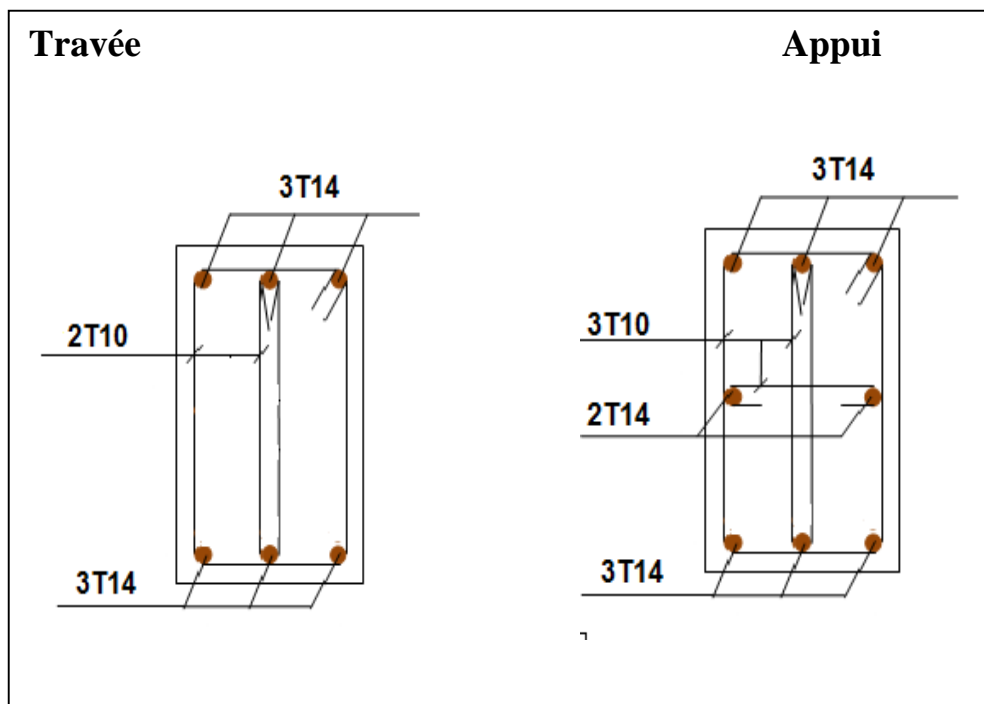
Schéma de ferrailage des poutres secondaire
